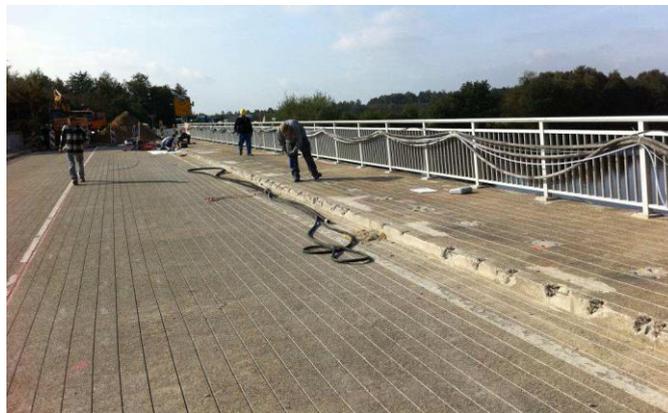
Fahrbahnoberseite der Straßenbrücke nach Erstellung der Schlitze zur Einbettung der Anodenbänder
